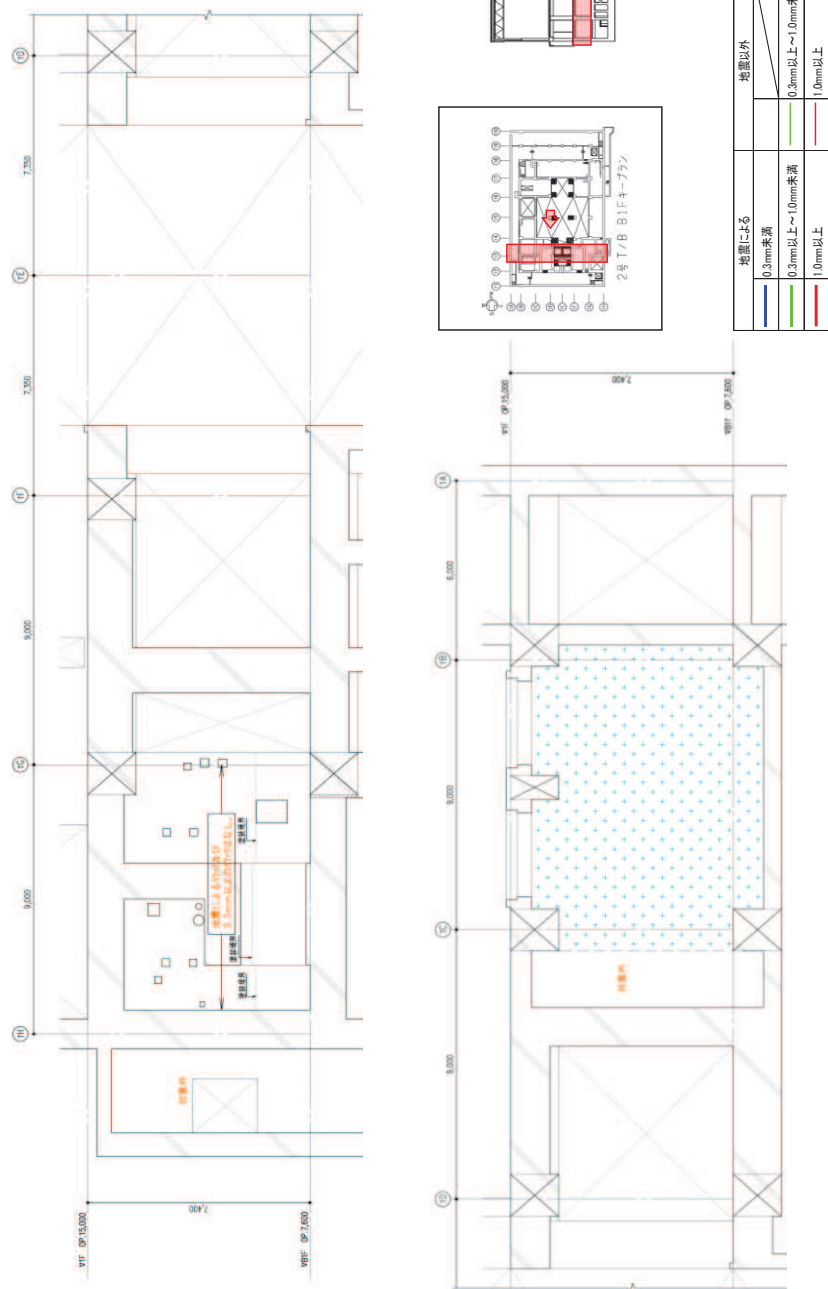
タービン建屋のひび割れ分布 耐震壁 (19) 地下 1 階 T3 通り
